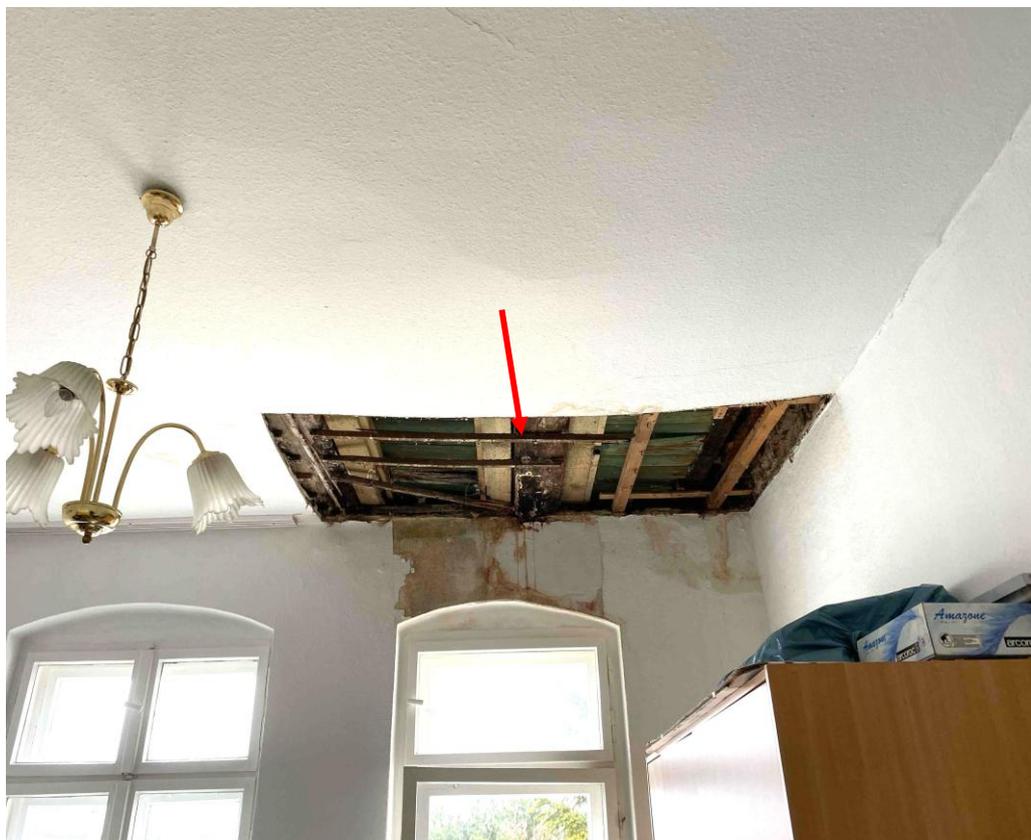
Ansicht freigelegte Balkenlage im 4. OG unterhalb der Dachterrasse (Foto covivio GmbH)
